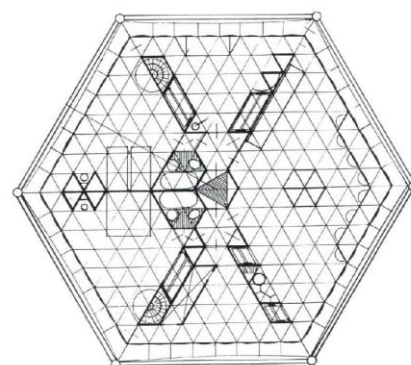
Planta Dymaxion House, fase proyecto. Buckminster Fuller, R., 1929.
